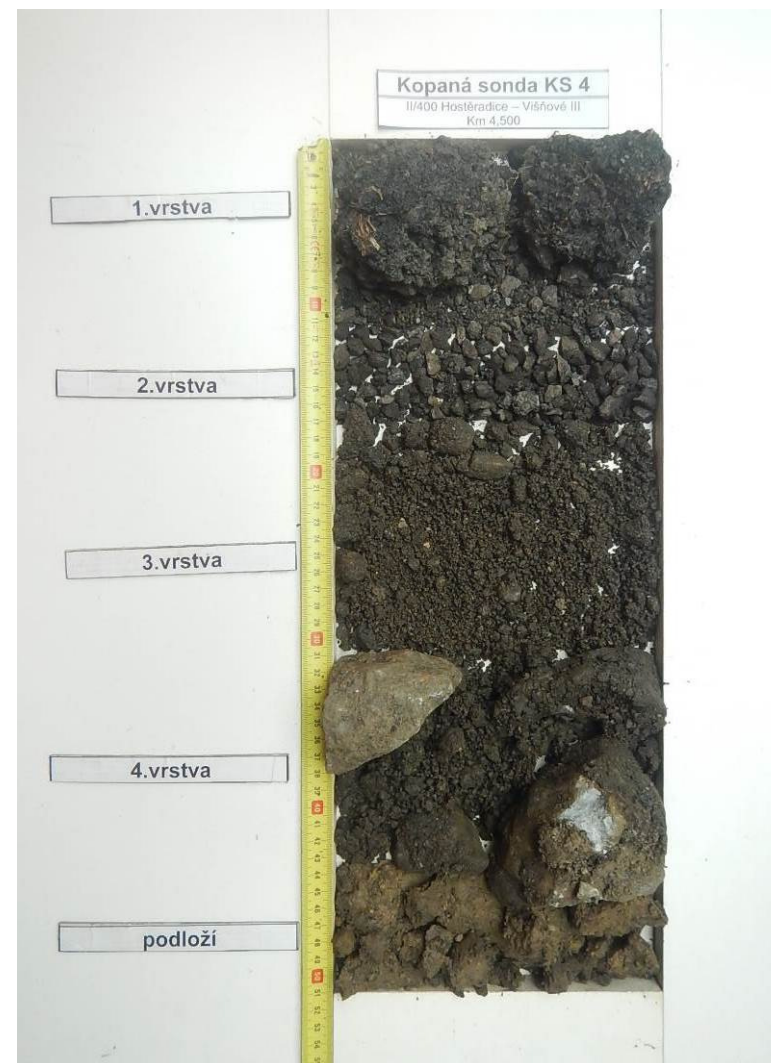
a č. 8 - Kopaná sonda KS 4
